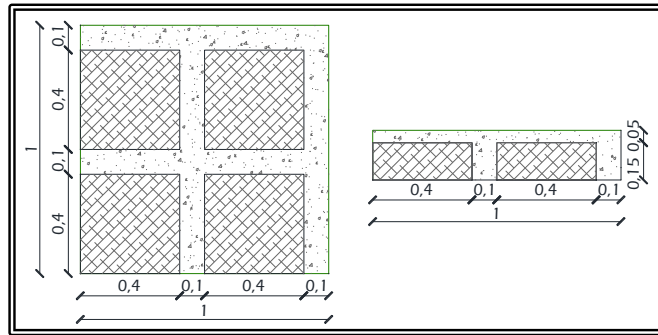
Vista en planta y elevación losa de 1m x 1m.
